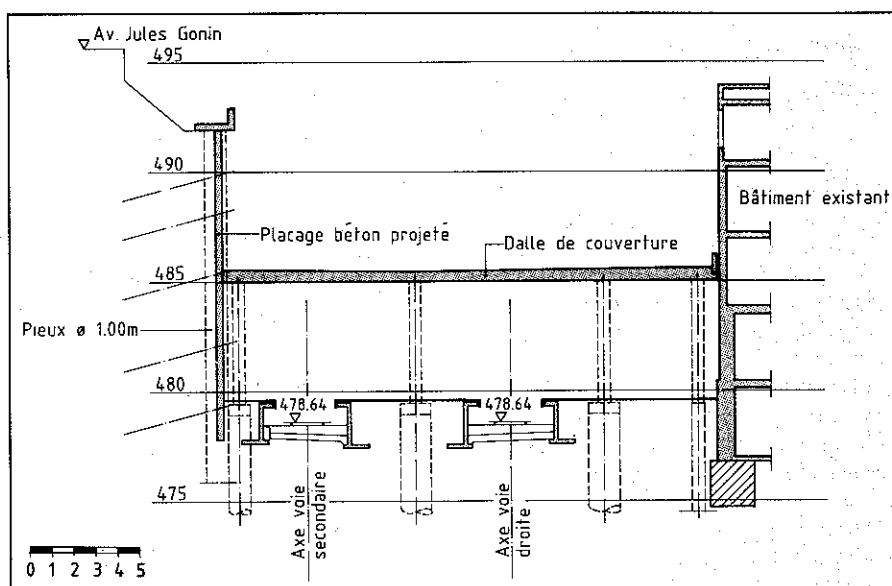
Station de Lausanne-Flon : coupe transversale.
